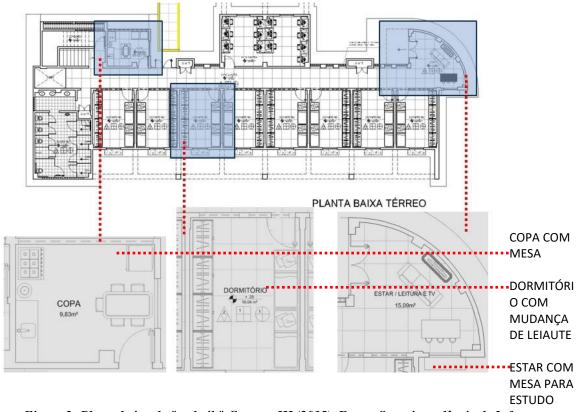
Planta baixa do "as built" Campus III (2015). Fonte: Superintendência de Infraestrutura da UFRN, editado.
